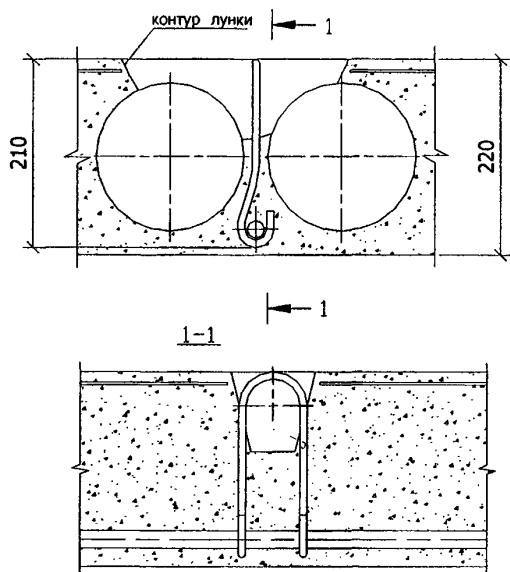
Конструкция строповочной петли с подгибом ветвей и крюками, заводимыми за рабочую арматуру, для многопустотных плит перекрытий
